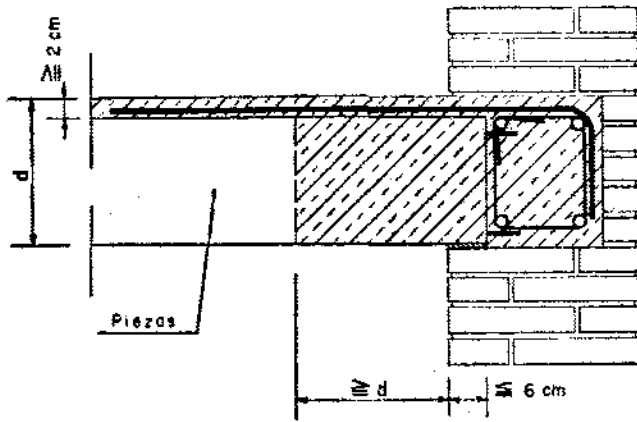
Cadena con viguetas autorresistentes sin suficiente armadura saliente
